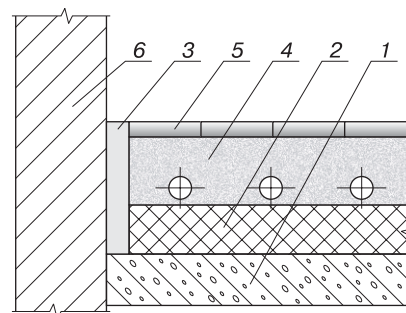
Конструкция системы напольного отопления: 1 — основа; 2 — тепло- и гидроизоляция; 3 — демпферная лента; 4 — нагревательный слой с металлополимерной трубой; 5 — декоративно-отделочный слой; 6 — стена
